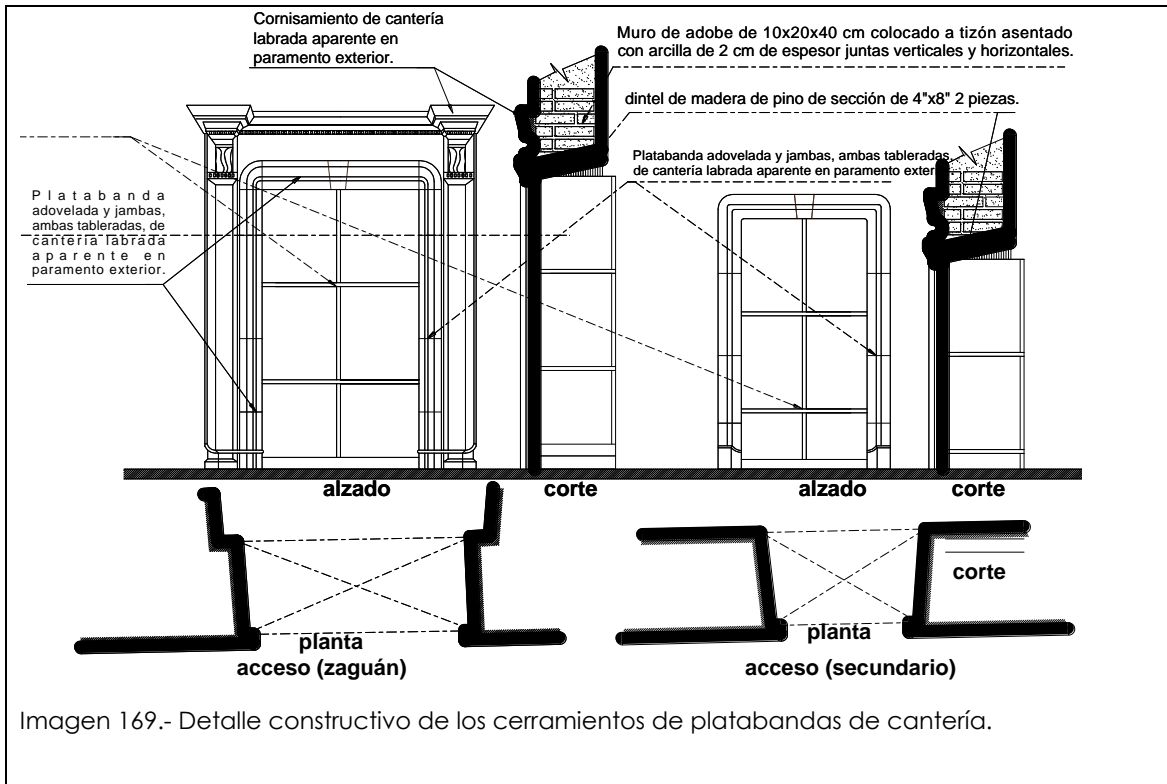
Detalle constructivo de los cerramientos de platabandas de cantería.
